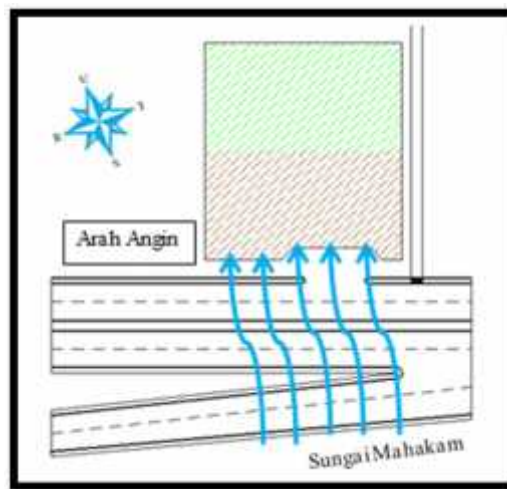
Lokasi Site Terpilih Jalan R.E Martadinata Kota Samarinda
